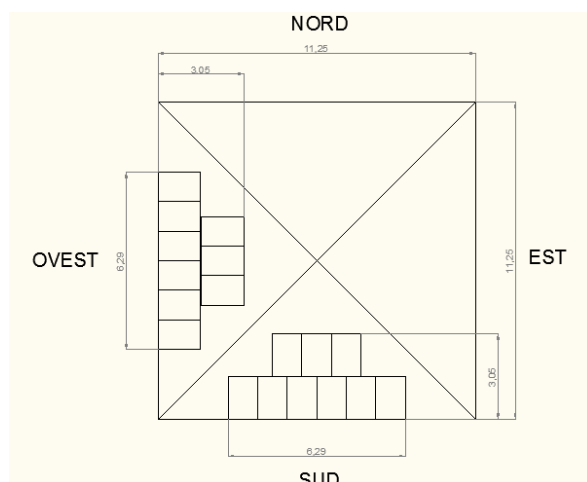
Planimetria dell'impianto fotovoltaico.
